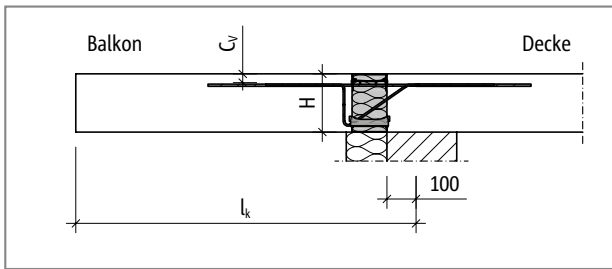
Schöck Isokorb® Typ KXT: Statisches System
